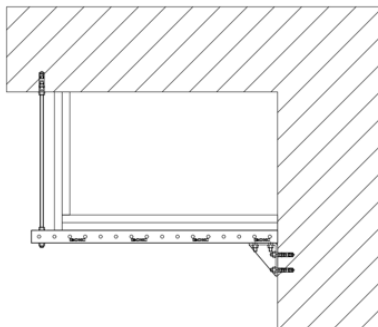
Крепление короба с двумя стенками к несущей поверхности горизонтально
